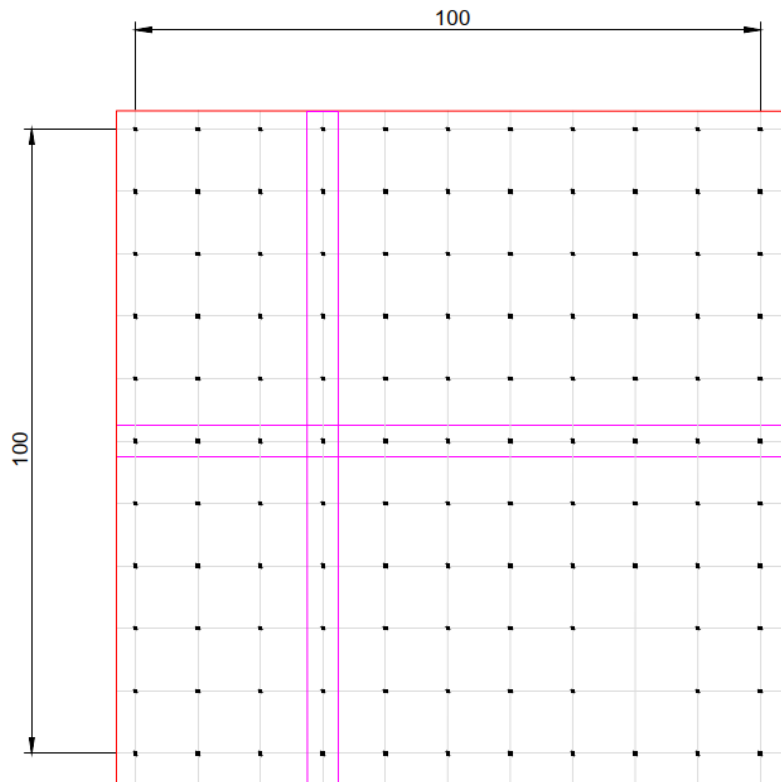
Pianta dell'edificio alla quota di estradosso della fondazione
